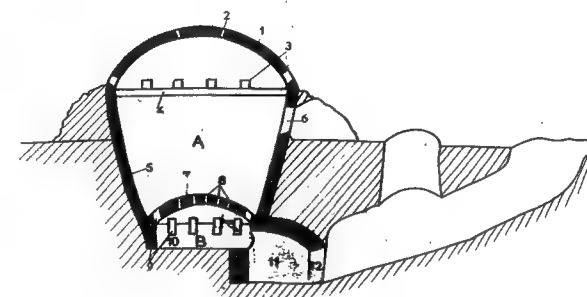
Coupe schématique des fondations d'un four de potier :
